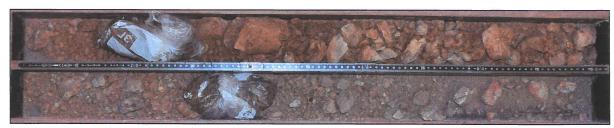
Erkundungsstelle FB5 – Bohrgut Kleinrammbohrung
